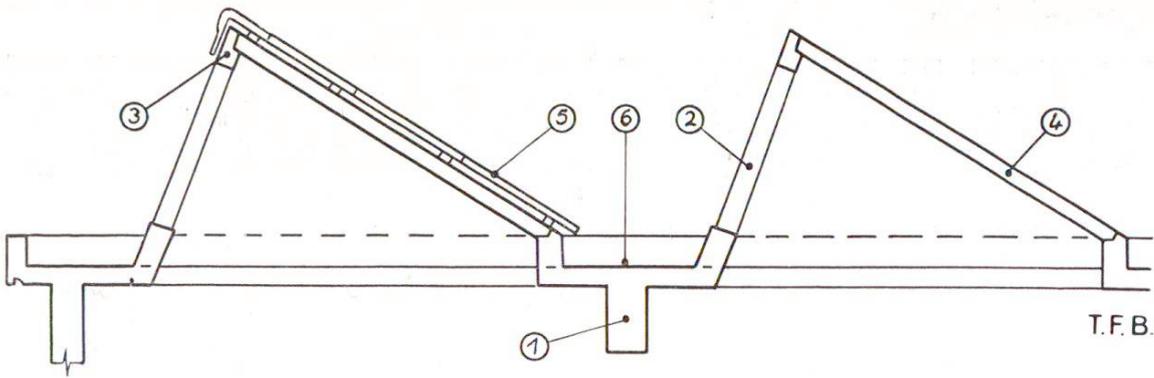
Coupe à travers la construction en sheds. 1. Poutre précontrainte en forme de gouttière, longueur 21 m. 2. Poinçons placés tous les 2,05 m. 3. Pannes par éléments de 2,04 m de longueur. 4. Dalles en béton léger. 5. Eternit ondulé. 6. Gouttière avec isolation
